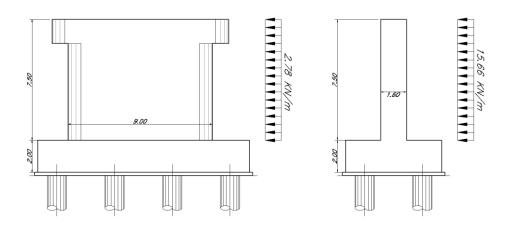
Carico distribuito longitudinale e trasversale del vento sulla pila
